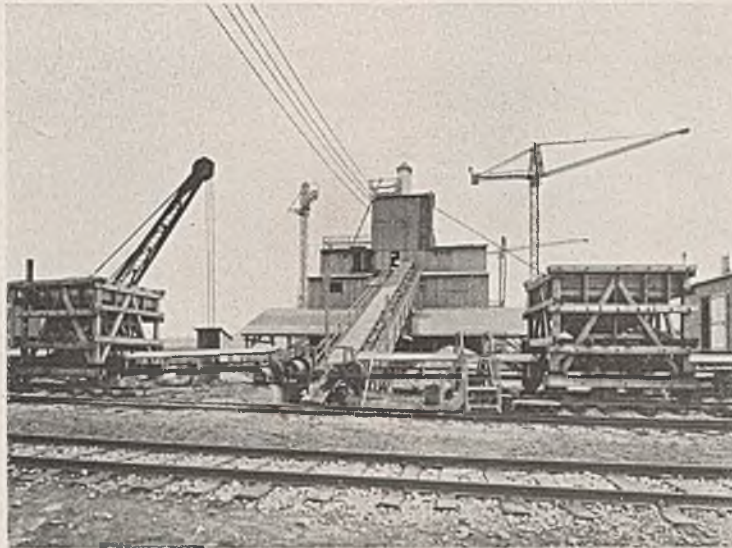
Betonfabrik vom Vollbahngleis aus gesehen.
